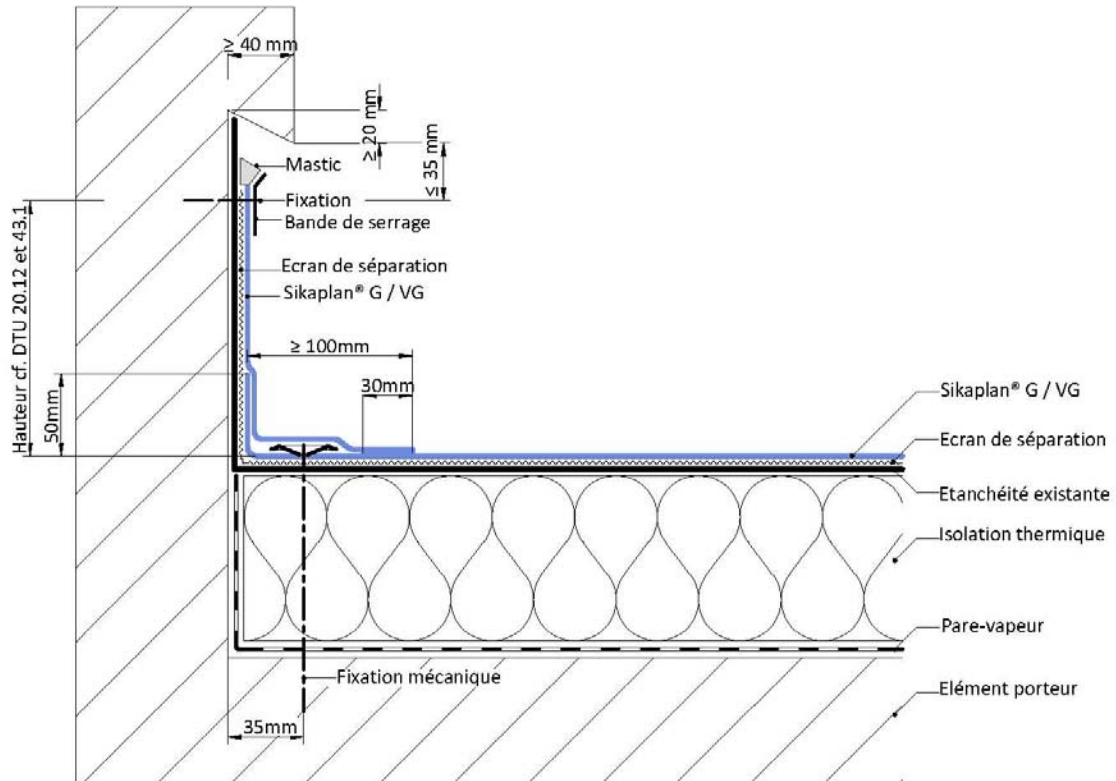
Relevé d'étanchéité sous engravure – Travaux de réfection sur maçonnerie
